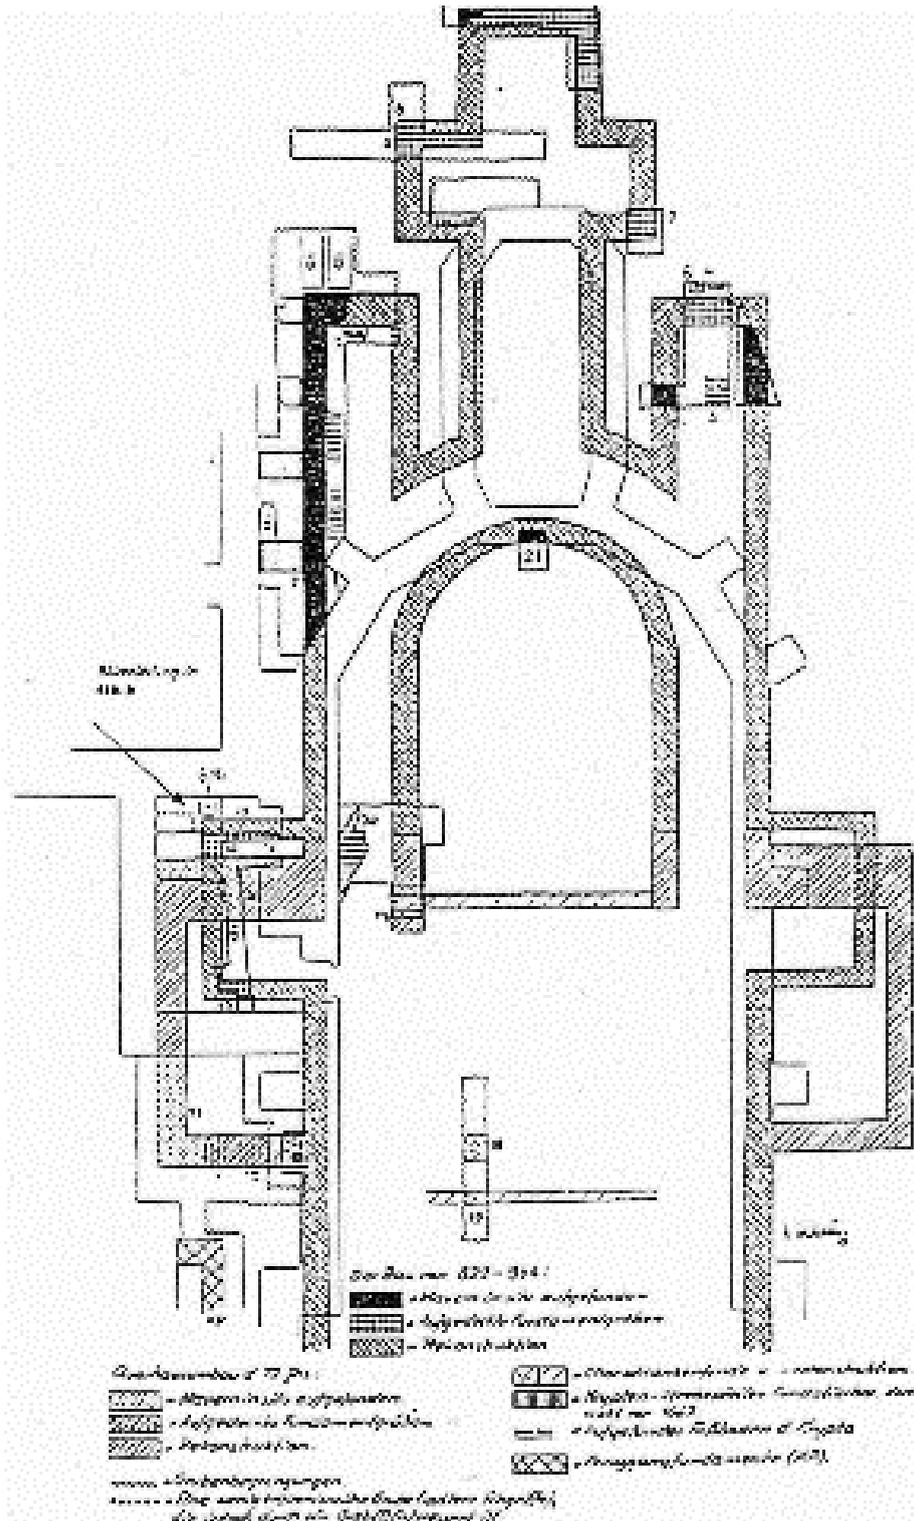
Grundrißrekonstruktion der karolingischen Kirche nach Claussen.
